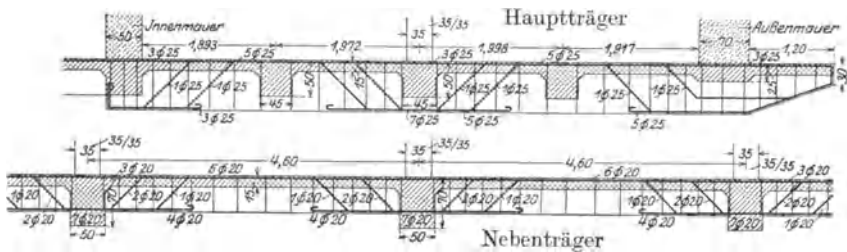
Abmessungen und Bewehrung der Fundamentplatte.
